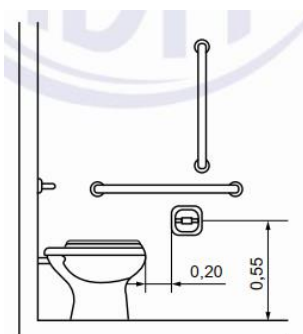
Localização da papeleira embutida – Vista lateral
